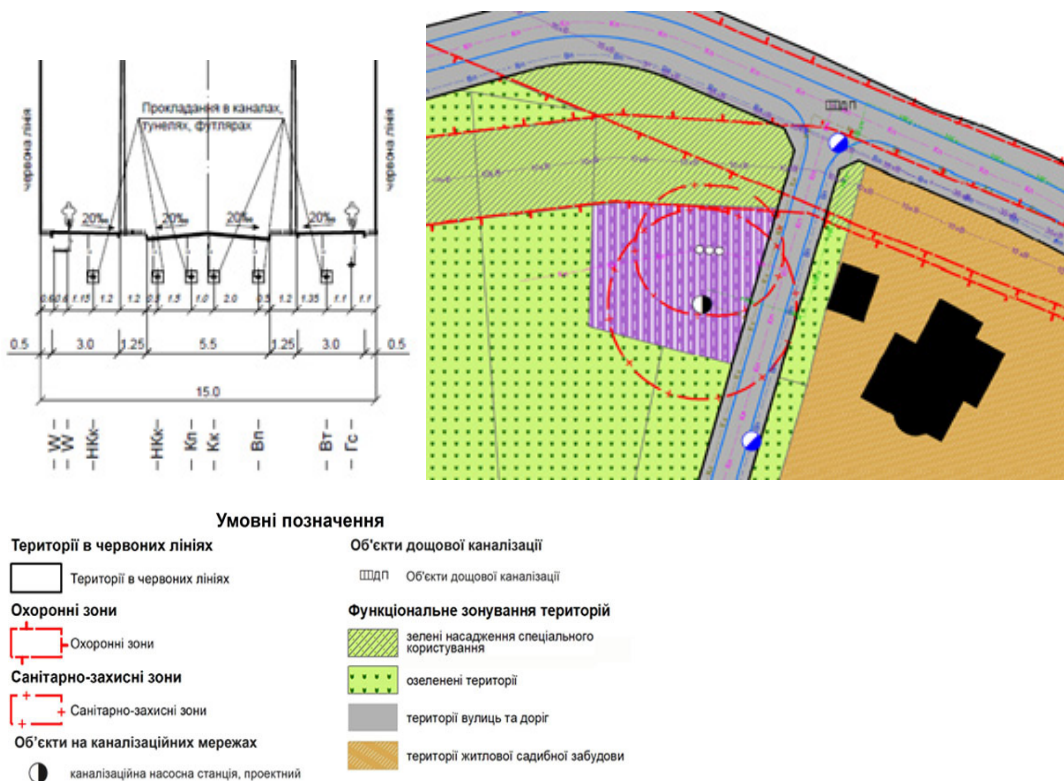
Поперечний профіль вулиці та фрагмент планувальних рішень генерального плану селища Докучаєвське Роганської територіальної громади Харківської області
